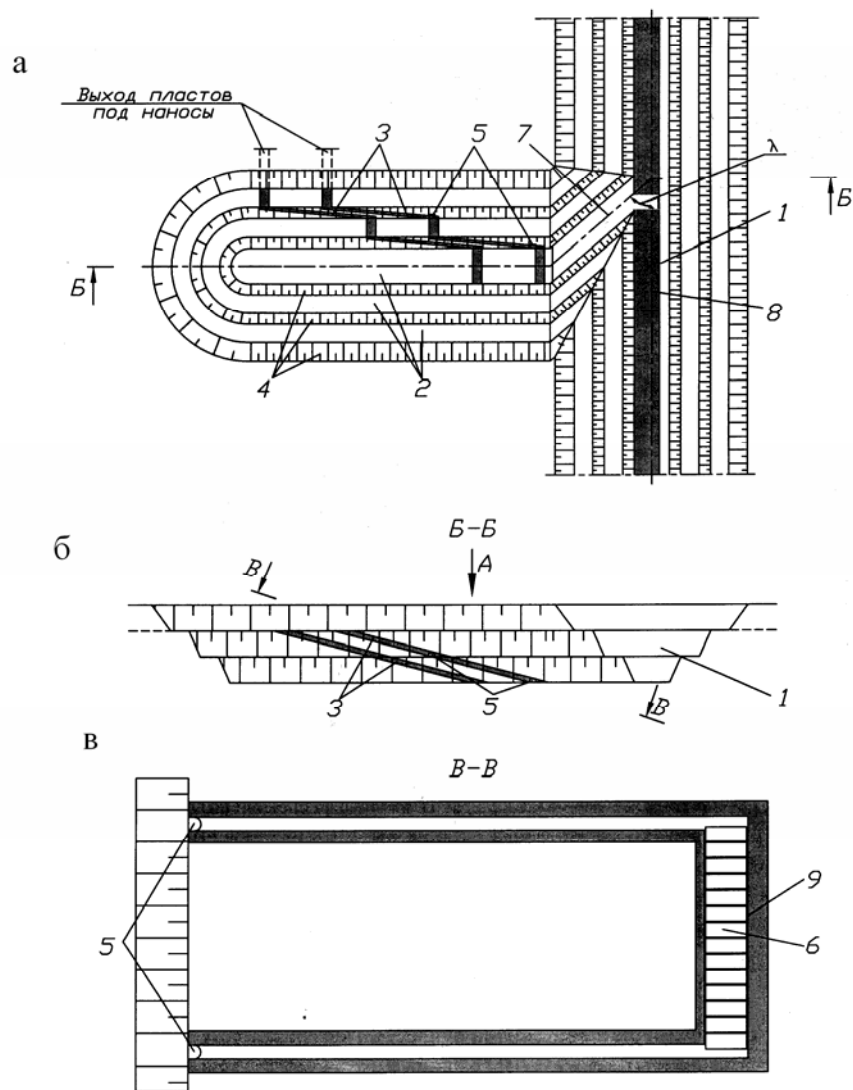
Комбинированный способ разработки свиты пологих угольных пластов: а – горизонтальная схема вскрытия шахтного поля разрезными траншеями; б – вертикальная схема вскрытия шахтного поля траншеями и горными выработками; в – разрез выемочного столба при подземной добыче угля [3]
